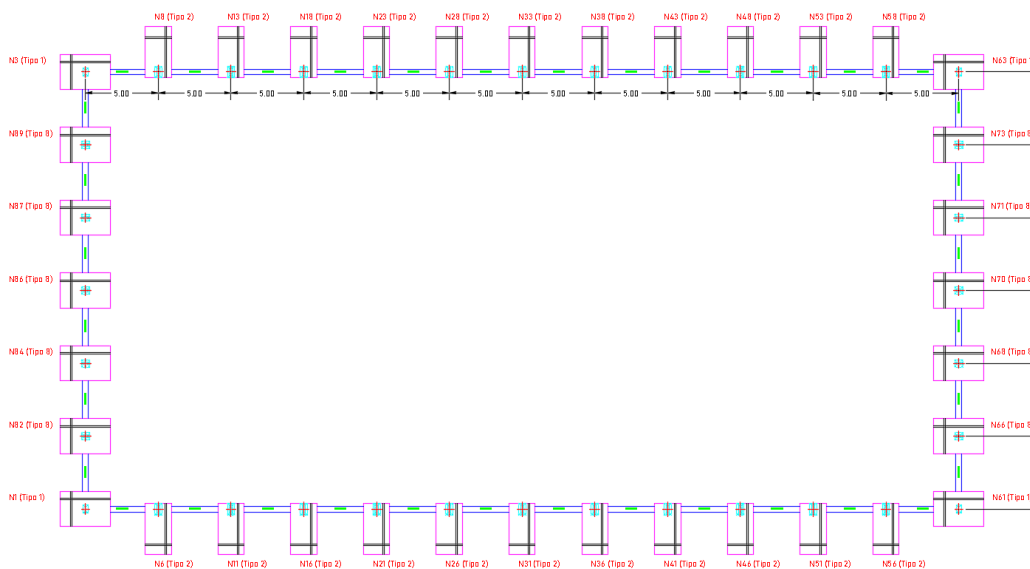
Plano de Cimentación. Zapatas y vigas de atado. Documento III-Planos.
